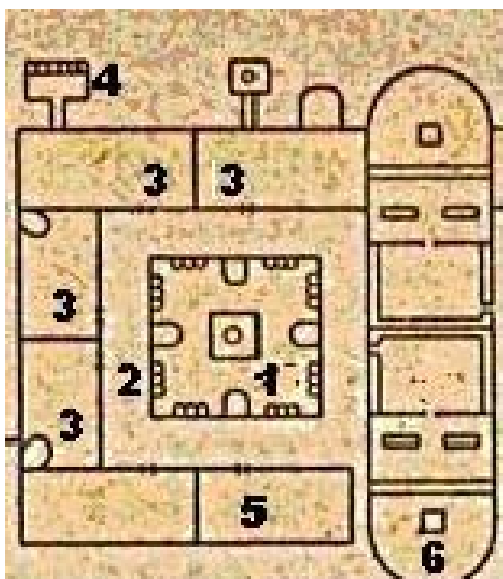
Planta da enfermaria do Monastério de St. Gall.
